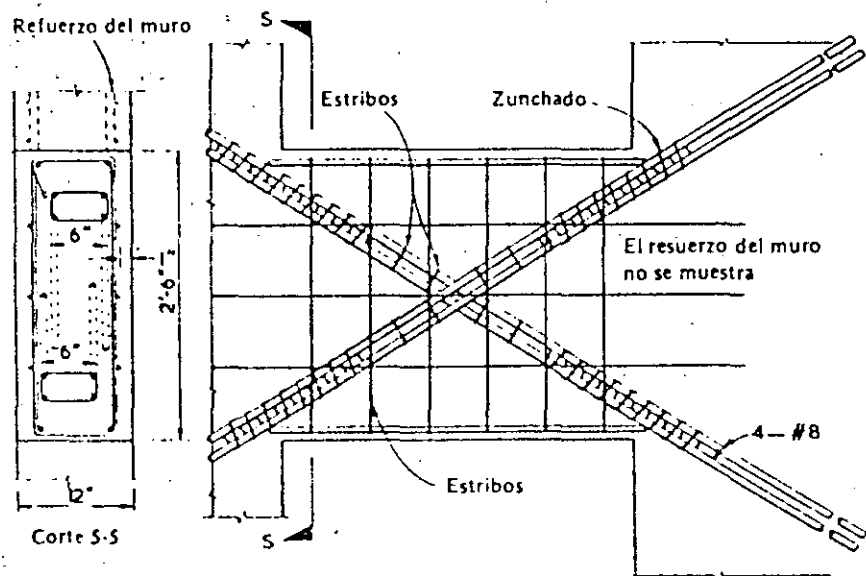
Refuerzo sugerido para una viga corta de acoplamiento (según Paulay^{3,34}).
